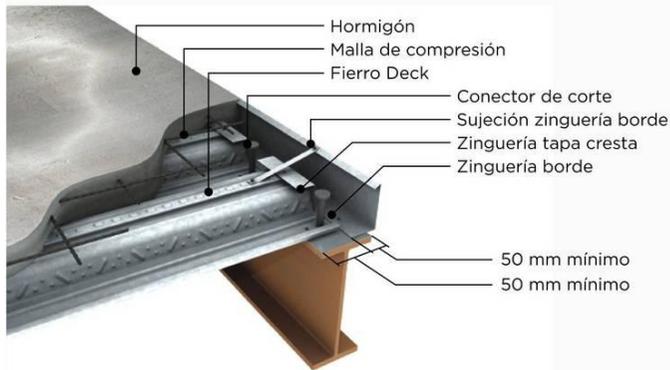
Esquema de losa con hormigón, Steel deck, vigas metálicas y conectores de cortante.
